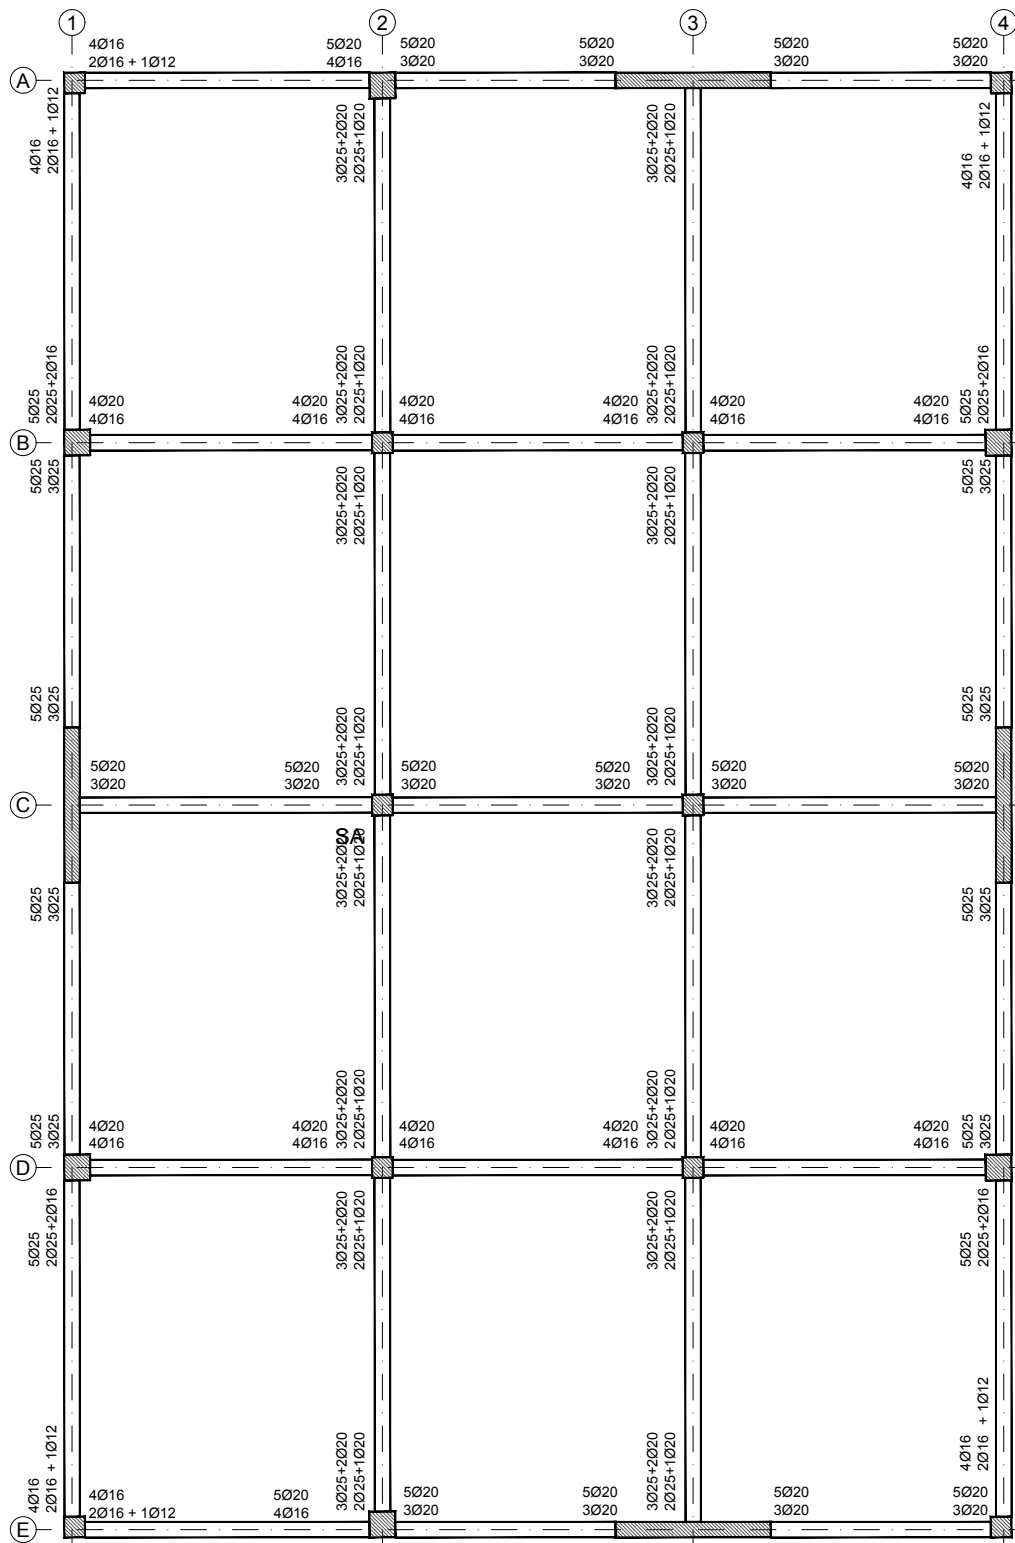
Armadura longitudinal das vigas – Piso 9.
